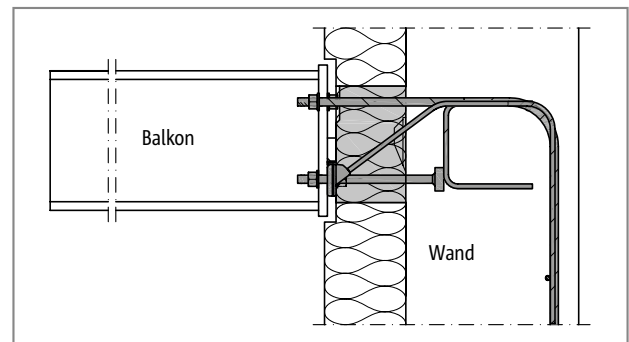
Schöck Isokorb® Typ KSXT14: Sonderkonstruktion für Wandanschluss auf Basis der Querkrafttragstufen -V8 oder -V10
